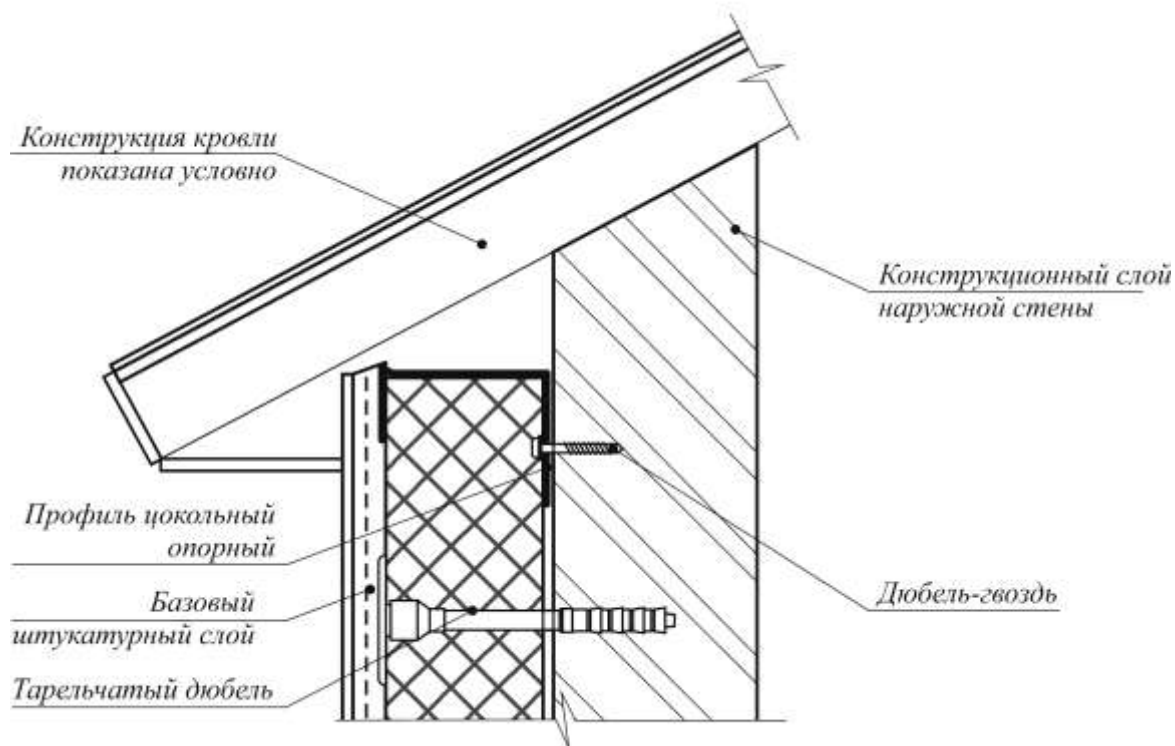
Узел примыкания наружной стены с тонким штукатурным слоем к скатной кровле
